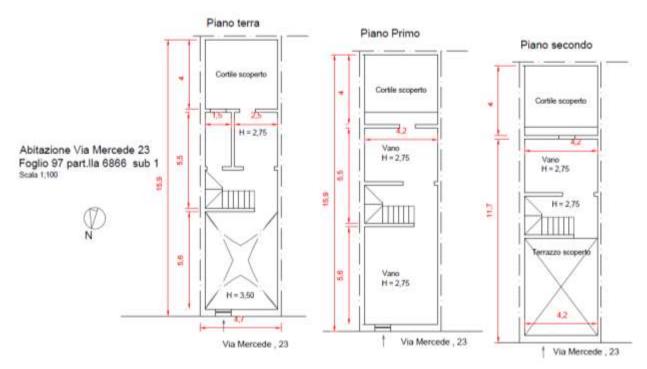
Planimetria abitazione piano T-1-2 via Mercede 23 come rilevato al sopralluogo
